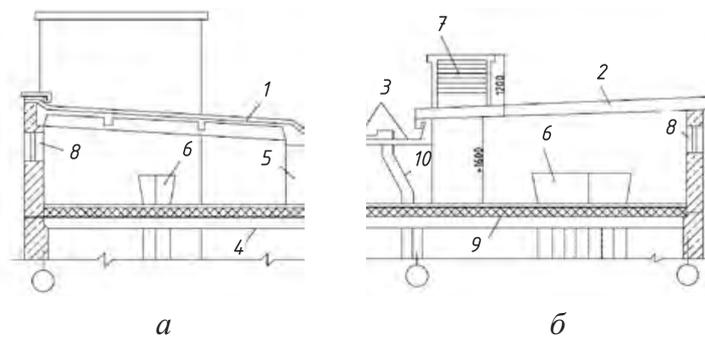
Схема крыши с холодным открытым чердаком: *а* — покрытие с рулонной кровлей; *б* — покрытие с безрулонной кровлей: 1 — железобетонная кровельная панель под рулонную кровлю; 2 — железобетонная кровельная панель с безрулонной кровлей; 3 — железобетонный водосборный лоток; 4 — панели перекрытия; 5 — опорная панель; 6 — оголовок вентиляционного блока; 7 — вытяжная вентиляционная шахта; 8 — вентилирующее отверстие в наружной стене; 9 — слой утеплителя с защитным слоем; 10 — утепленный патрубок внутреннего водостока
